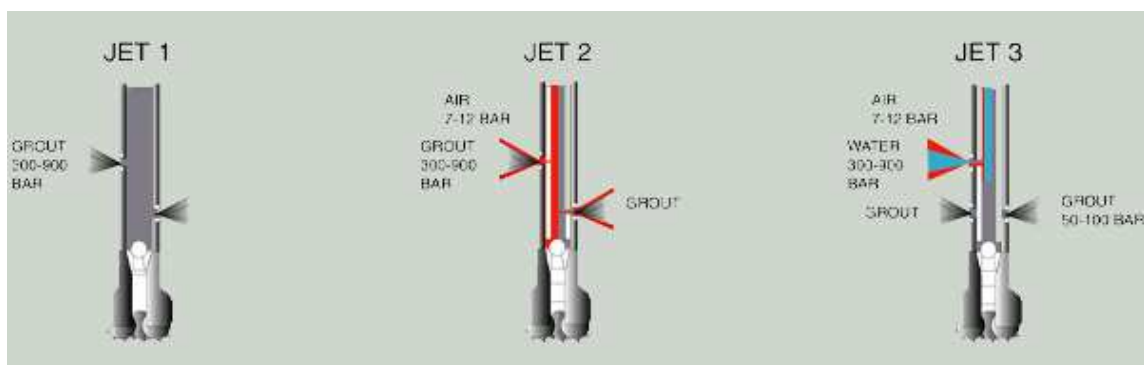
Sistemas de *Jet Grouting* (Geoconstruction, 2009).
